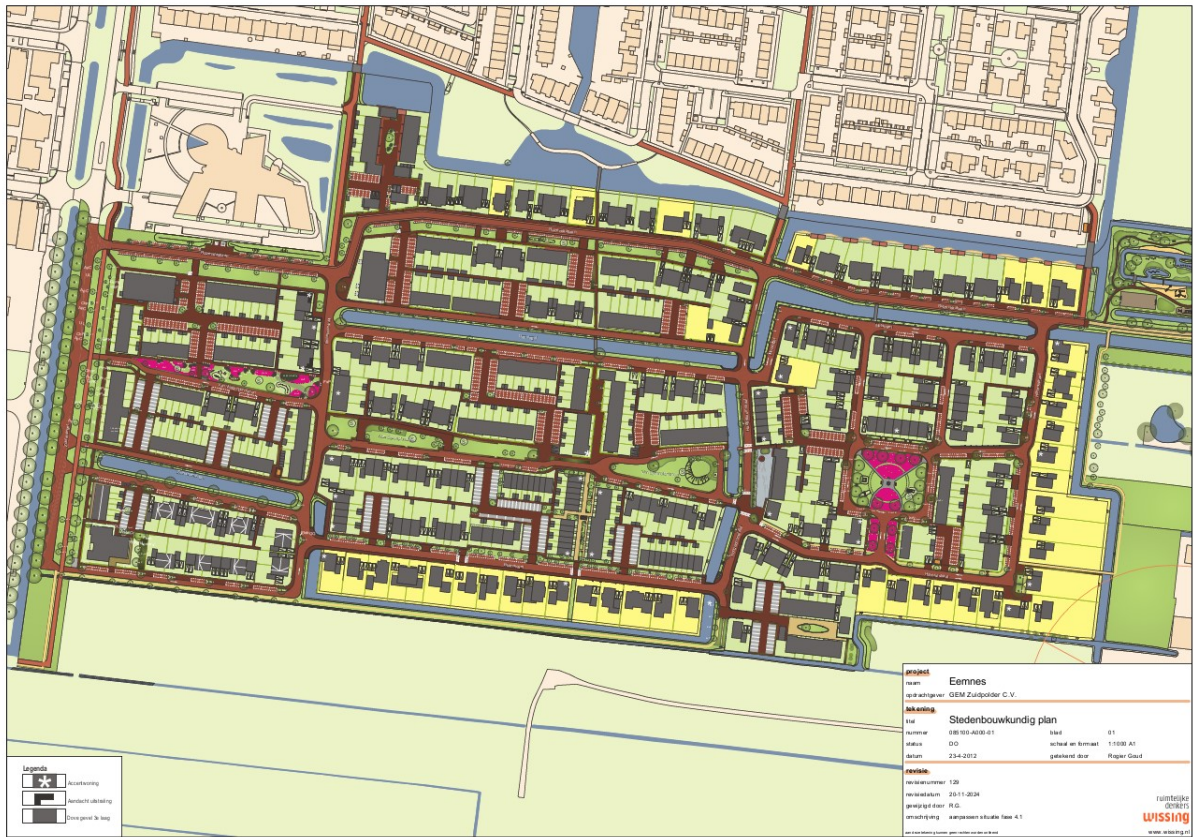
Verbeelding op stedenbouwkundig plan
